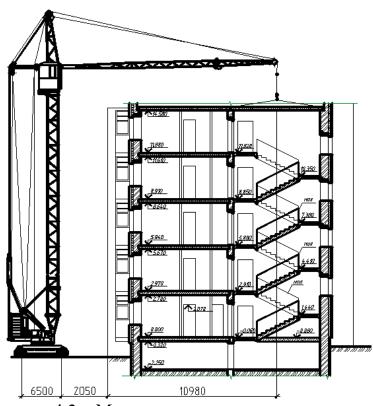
Монтаж плиты перекрытия краном МСК-10-20
